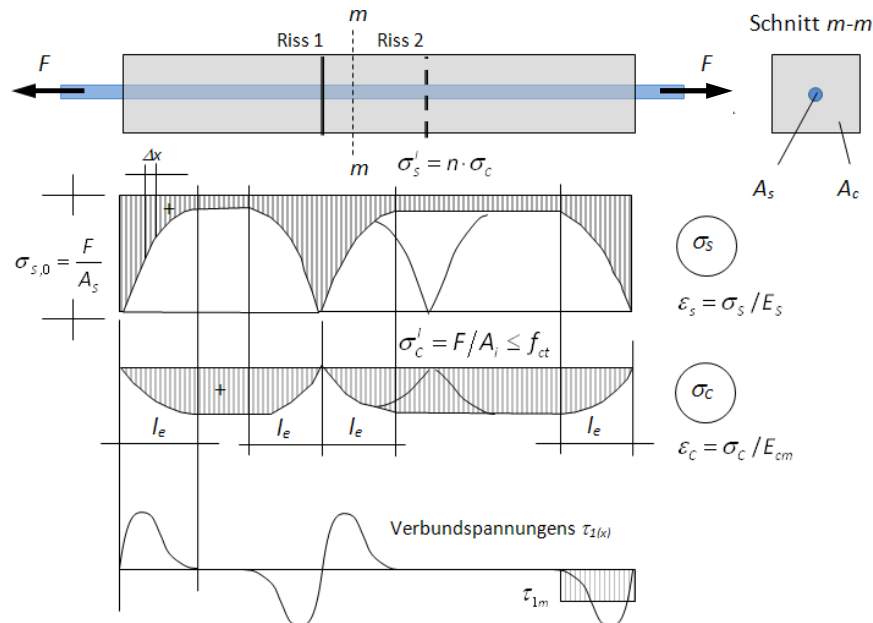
Spannungen zwischen Beton und Betonstahl bei Laststeigerung im Zustand II
